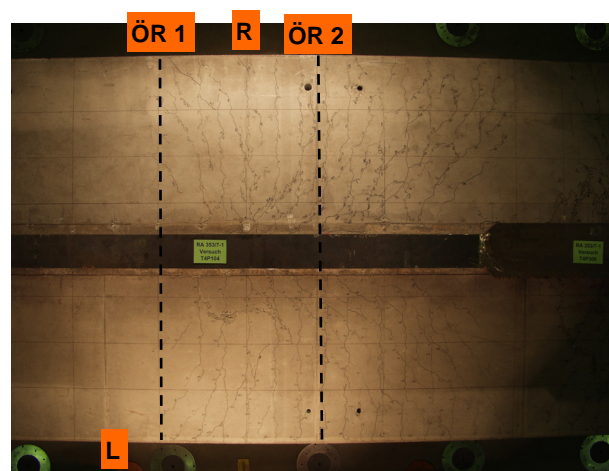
Rissbild auf der Betongurtunterseite
